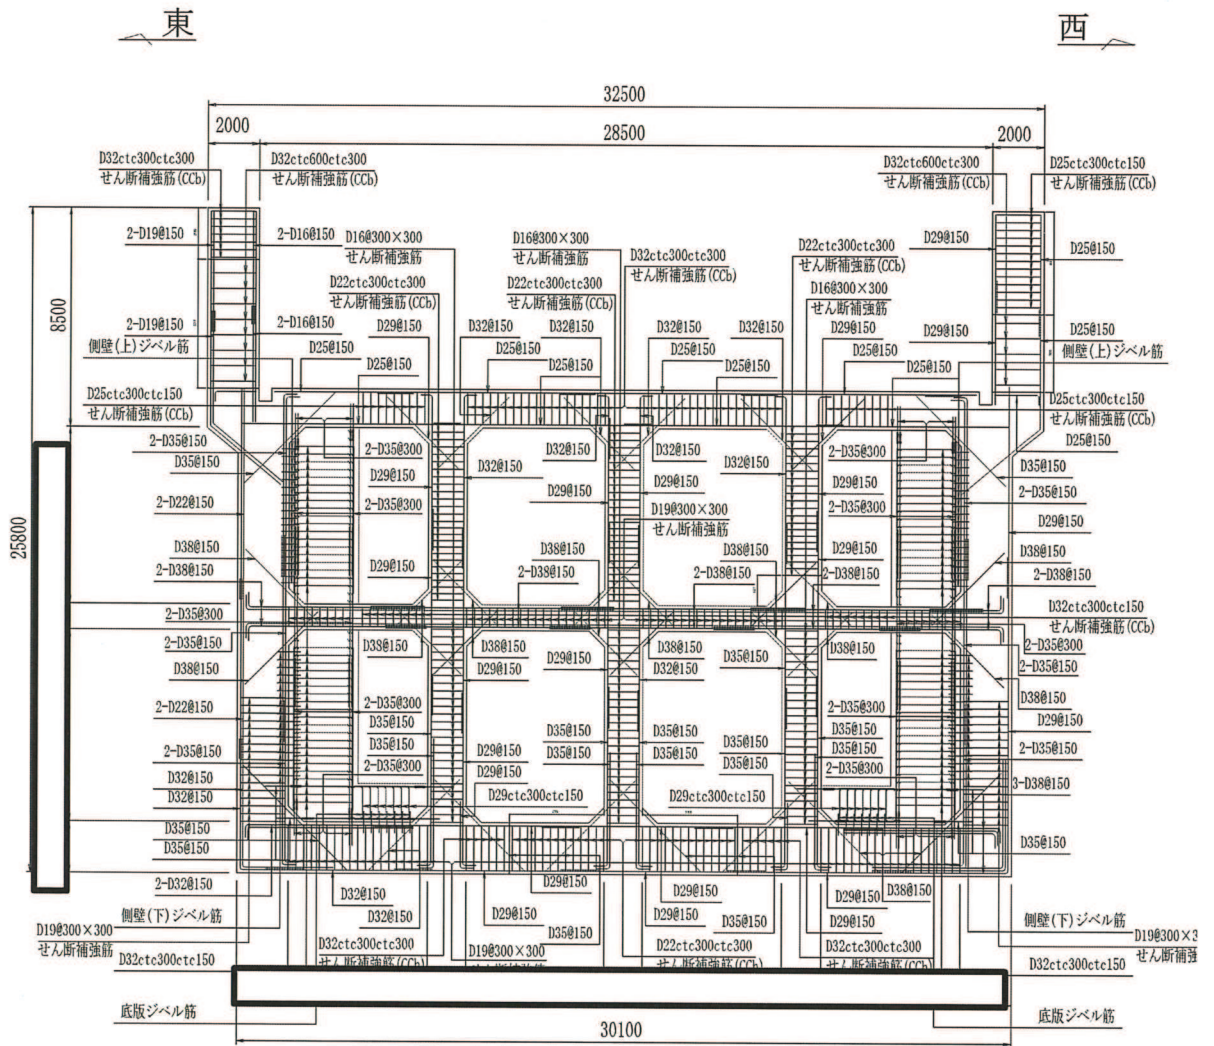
海水ポンプ室概略配筋図 (A-A 断面, 東西)
